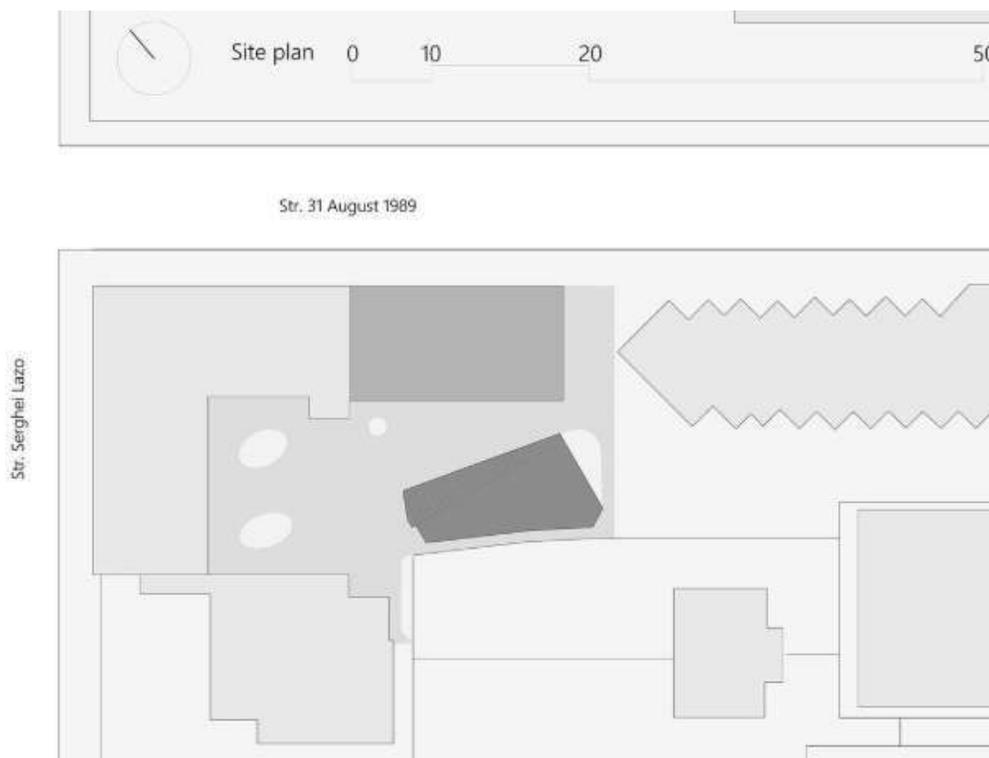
Planta de Conjunto. Fuente: Archdaily.
